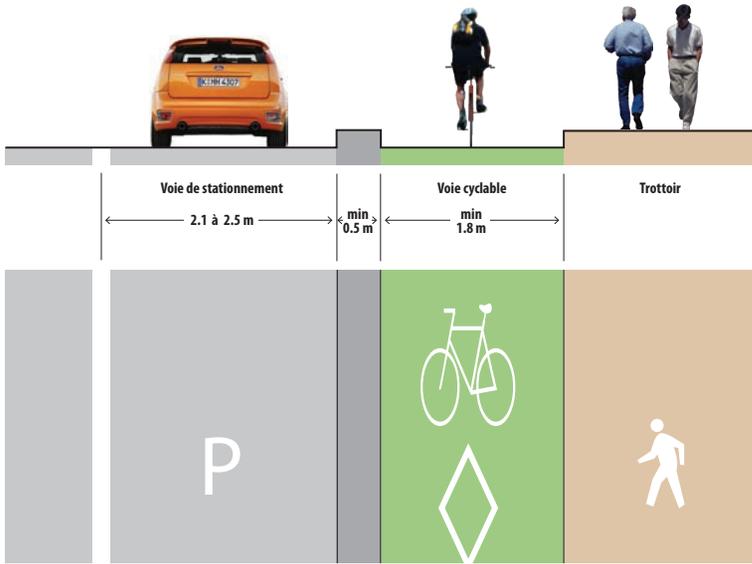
Installation unidirectionnelle séparée latéralement avec stationnement
